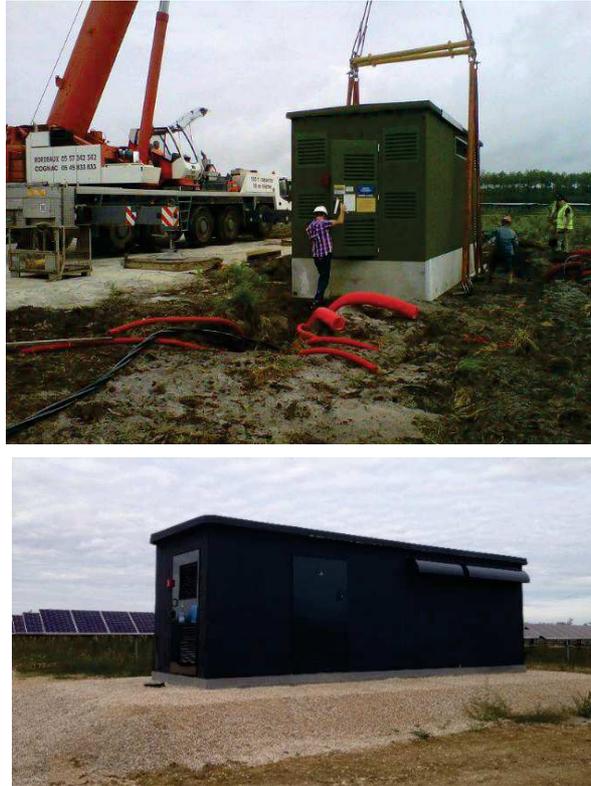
Exemple d'acheminement d'un poste de livraison préfabriqué (source : URBASOLAR, 2017)
